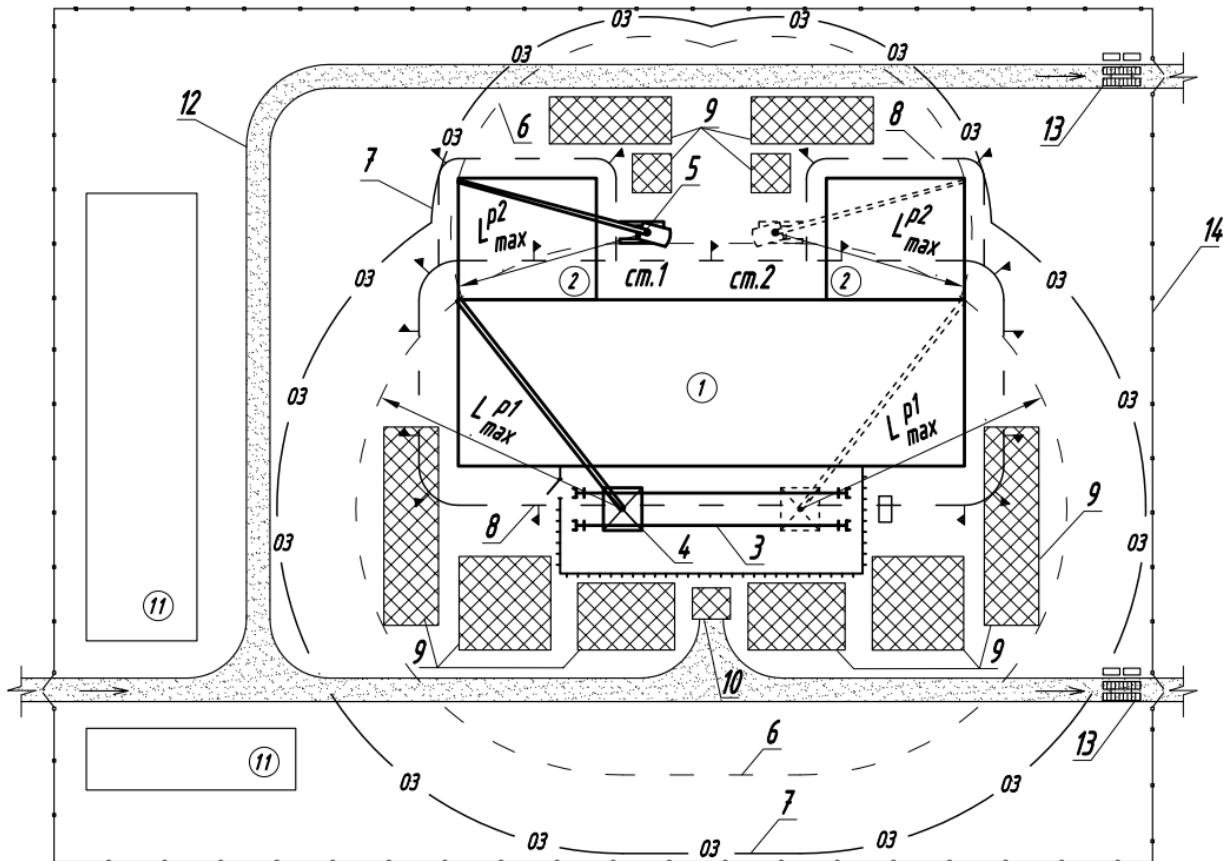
Схема организации работы башенного и самоходного кранов (технологическая зона): 1 – возводимое здание (девятиэтажная часть); 2 – возводимое здание (двухэтажная часть); 3 – подкрановые пути башенного крана; 4 – башенный кран; 5 – самоходный стреловой кран; 6 – граница суммарной зоны действия кранов; 7 – граница суммарной опасной зоны кранов; 8 – границы опасной зоны от падения грузов со здания; 9 – открытые площадки технологического назначения, склады; 10 – место приемки и разгрузки бетонной смеси (раствора); 11 – временные здания и сооружения; 12 – временная автомобильная дорога; 13 – мойка для колес; 14 – временное ограждение строительной площадки
